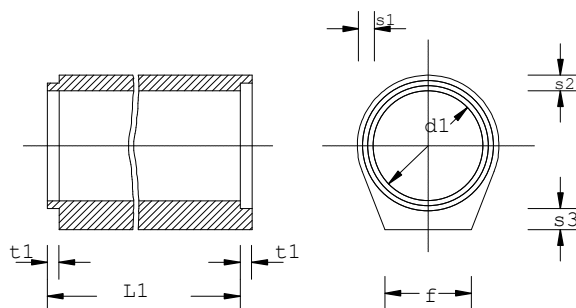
tubi in calcestruzzo di sezione circolare con giunto a risega e piede
